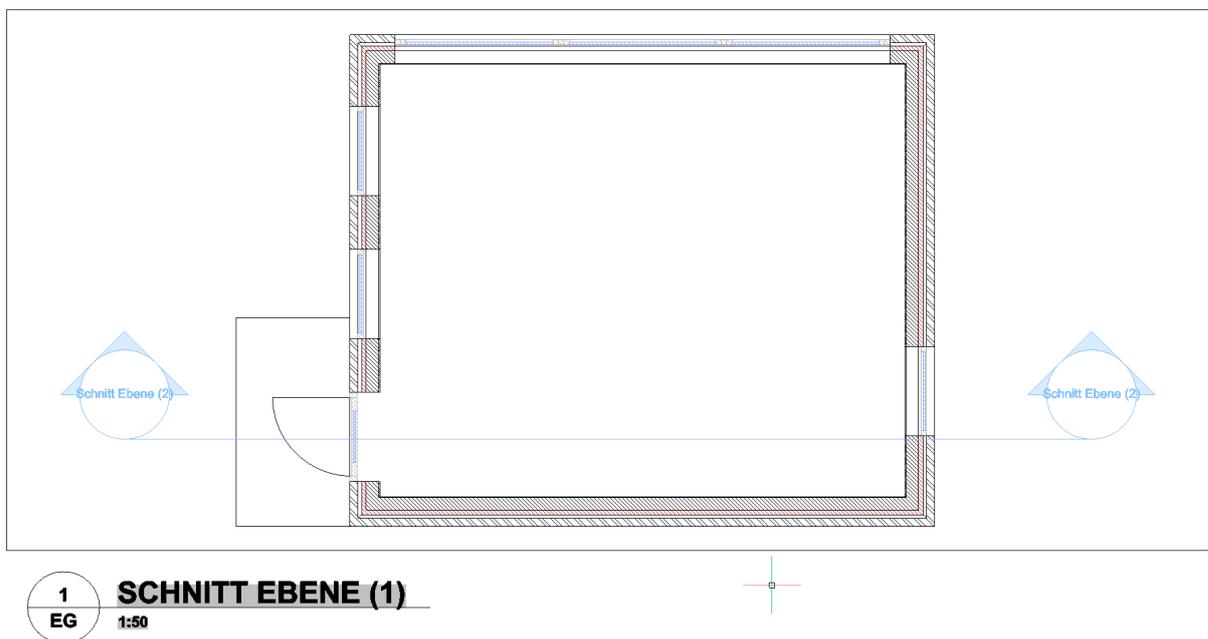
Aus dem Modell abgeleiteter 2D-Grundriss
